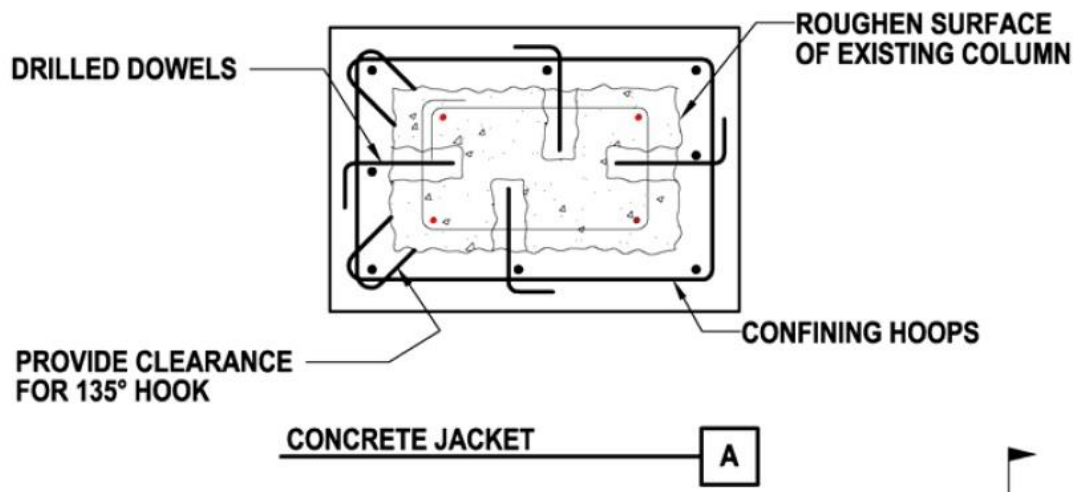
Columna con revestimiento de concreto. Adaptado de FEMA 547 Techniques for the Seismic Rehabilitation of Existing Buildings.
